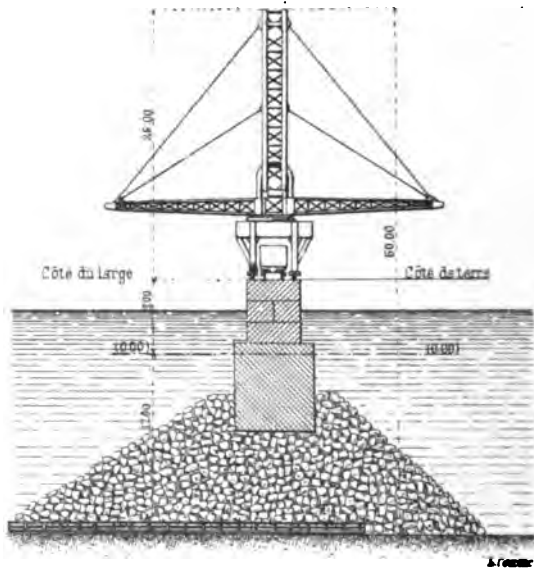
Coupe en travers de la jetée surmontée du Titan.
